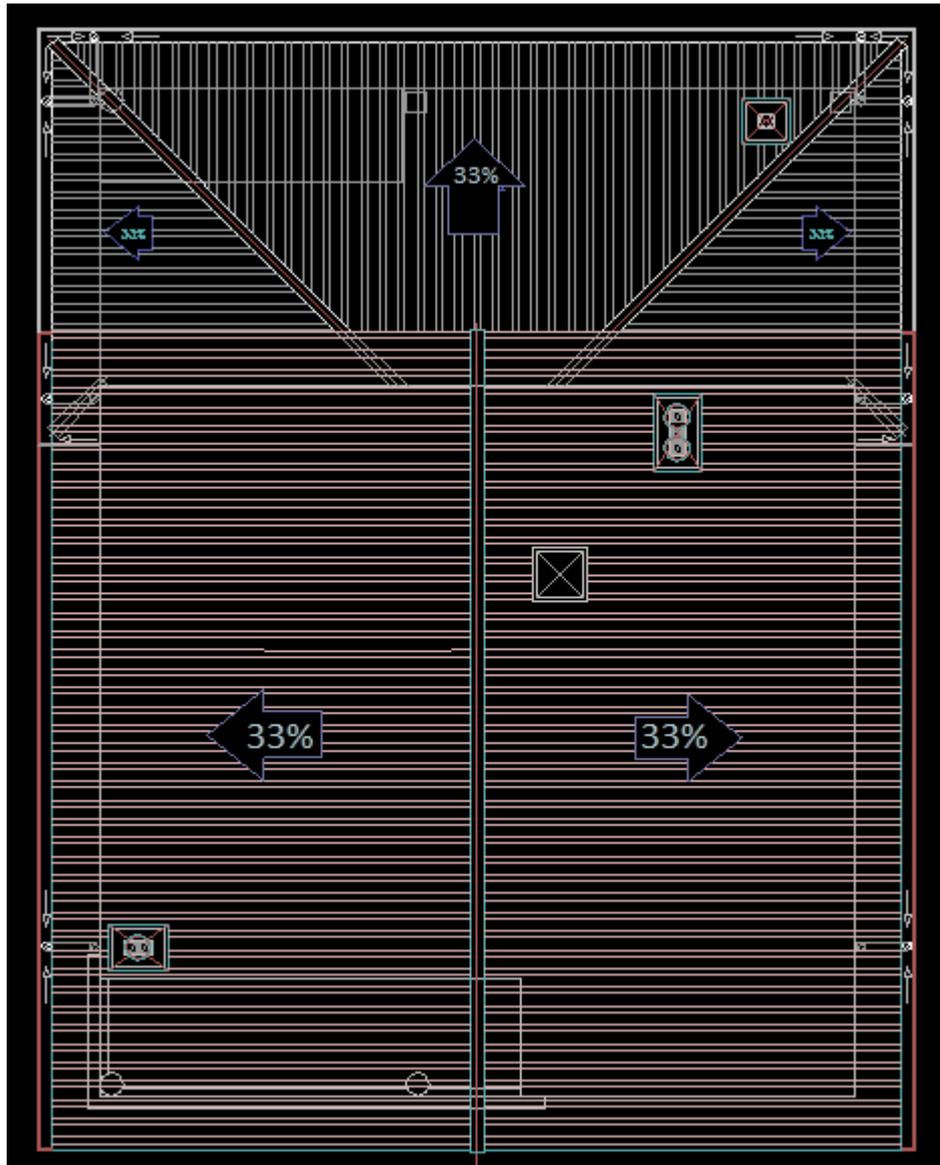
Plano de la cubierta de la vivienda. (Parte orientada al Sur y parte orientada al Norte)
